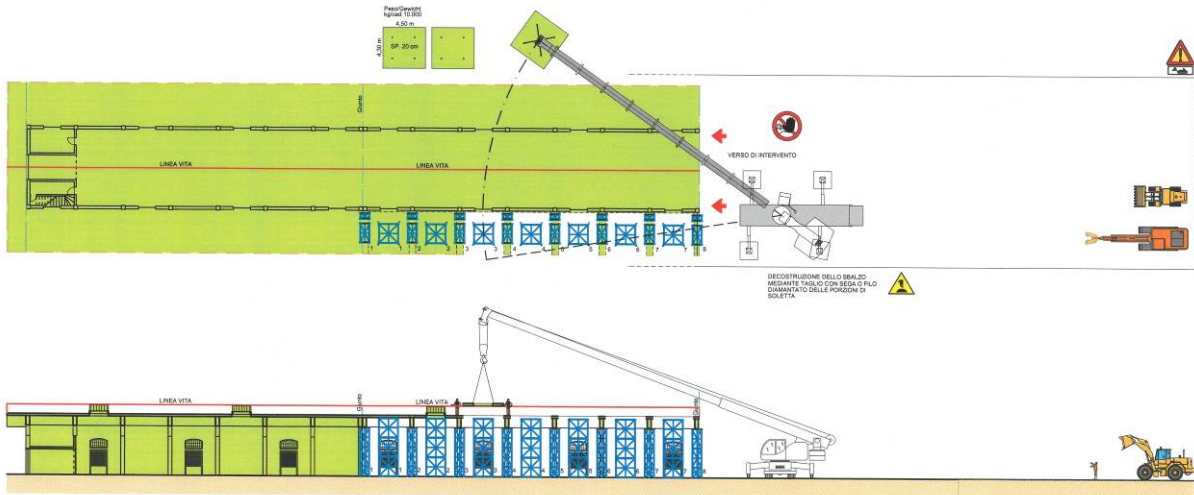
Planimetria e vista longitudinale Demolizione Edificio A9 – Decostruzione soletta
